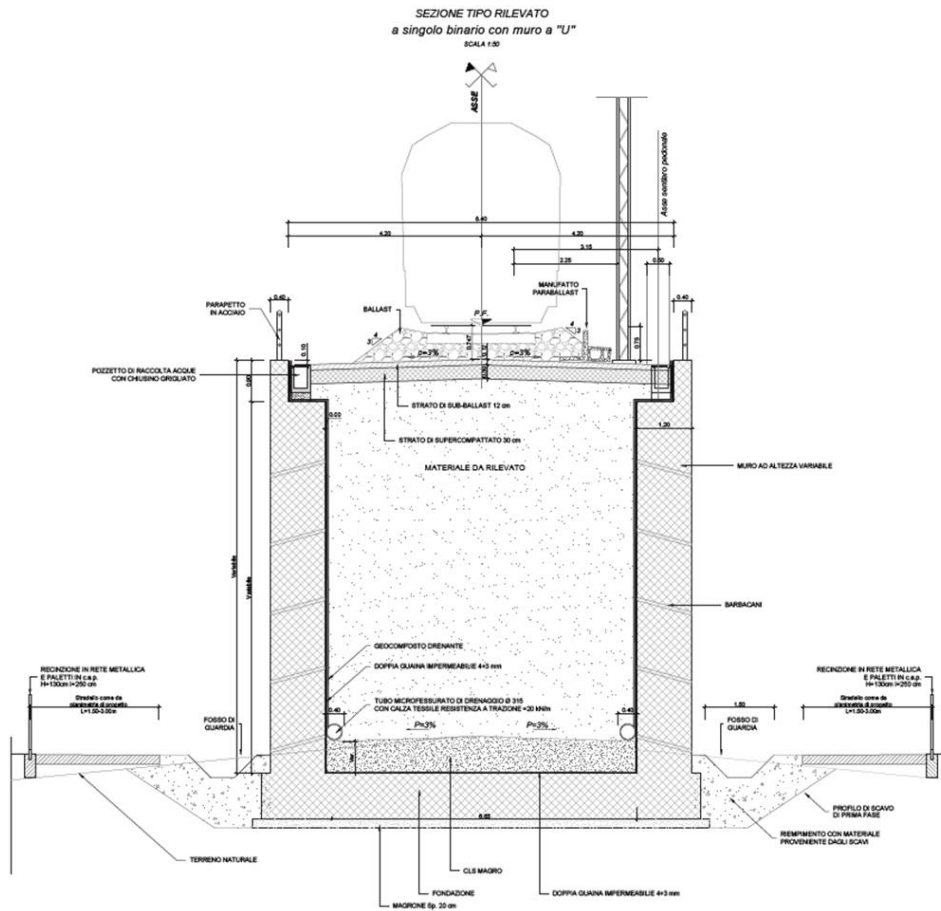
Sezione tipologica Rilevato tra Muri ad U
